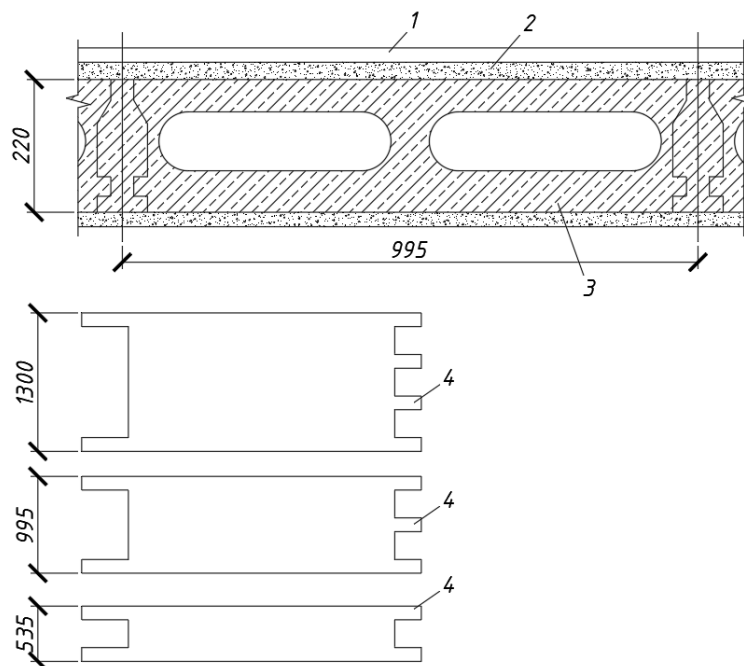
Збірні залізобетонні пустотні настили для заміни перекриттів:
